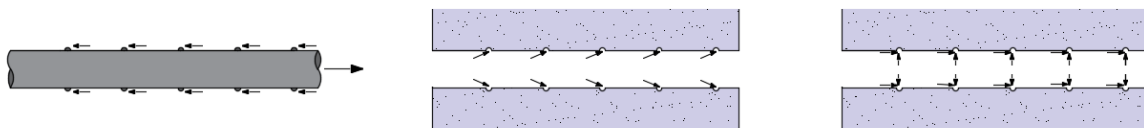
Fuerzas entre acero de refuerzo y concreto
